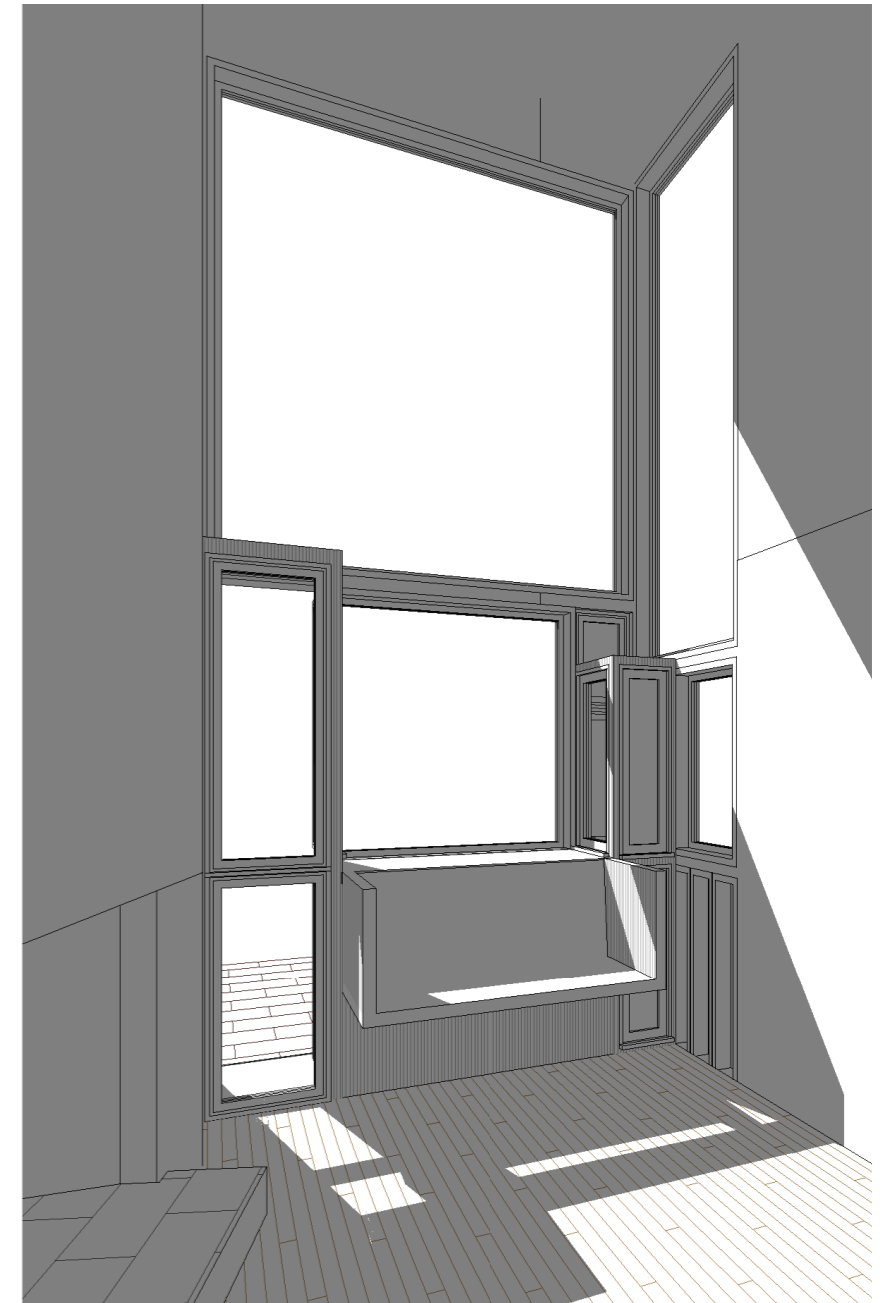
Vista cónica interior modelado en Revit del proyecto Fisher House. Detalle banco cedro.
